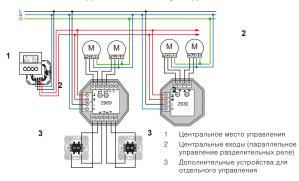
Схема подсоединения разделительного реле для наружного и скрытого монтажа
